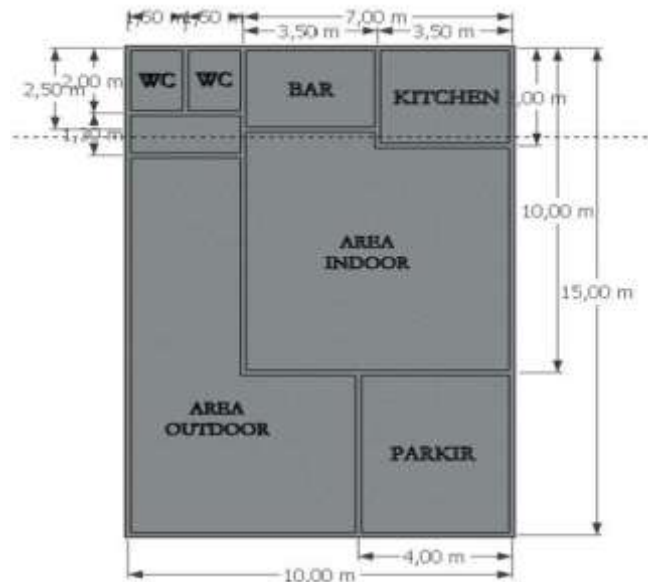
Alternatif Layout Pertama Bangunan Café Ruang Rasa
